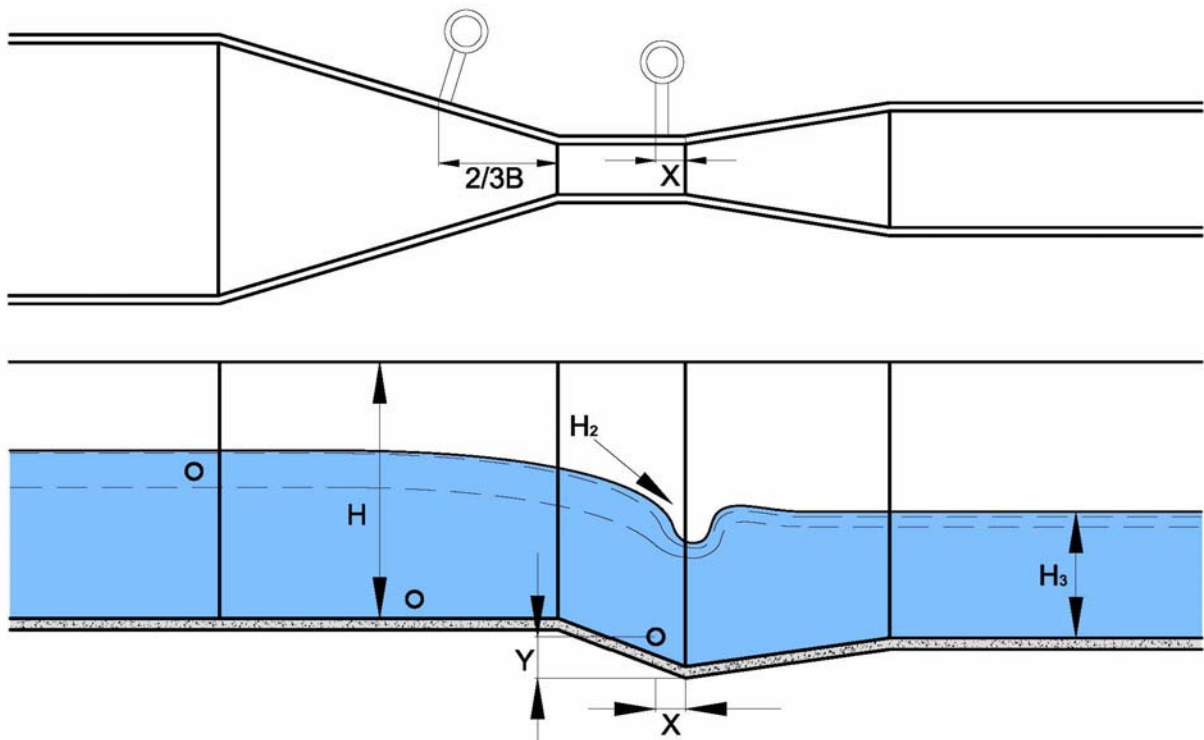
Planta y elevación de una canaleta Parshall
